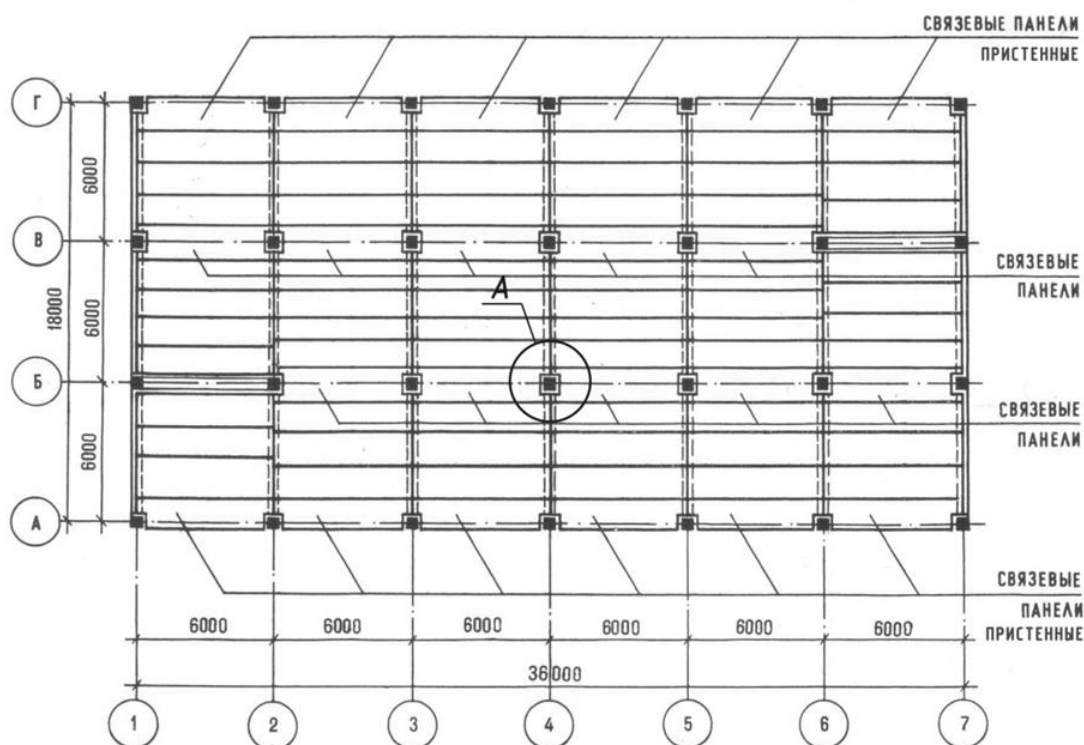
Расположение связевых плит (панелей) перекрытия в плане
